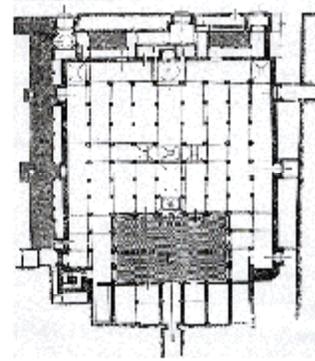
مسقط أفقي لجامع ابن صالح ببرائث
